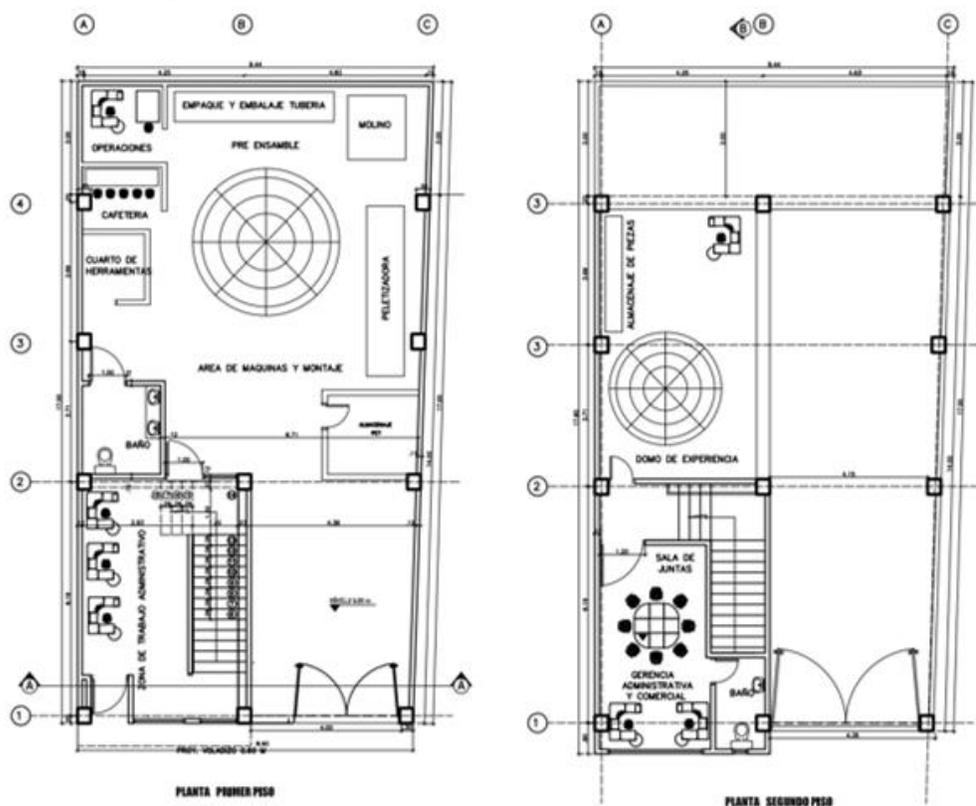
Arquitectura de planta física. Tomado de elaboración propia
